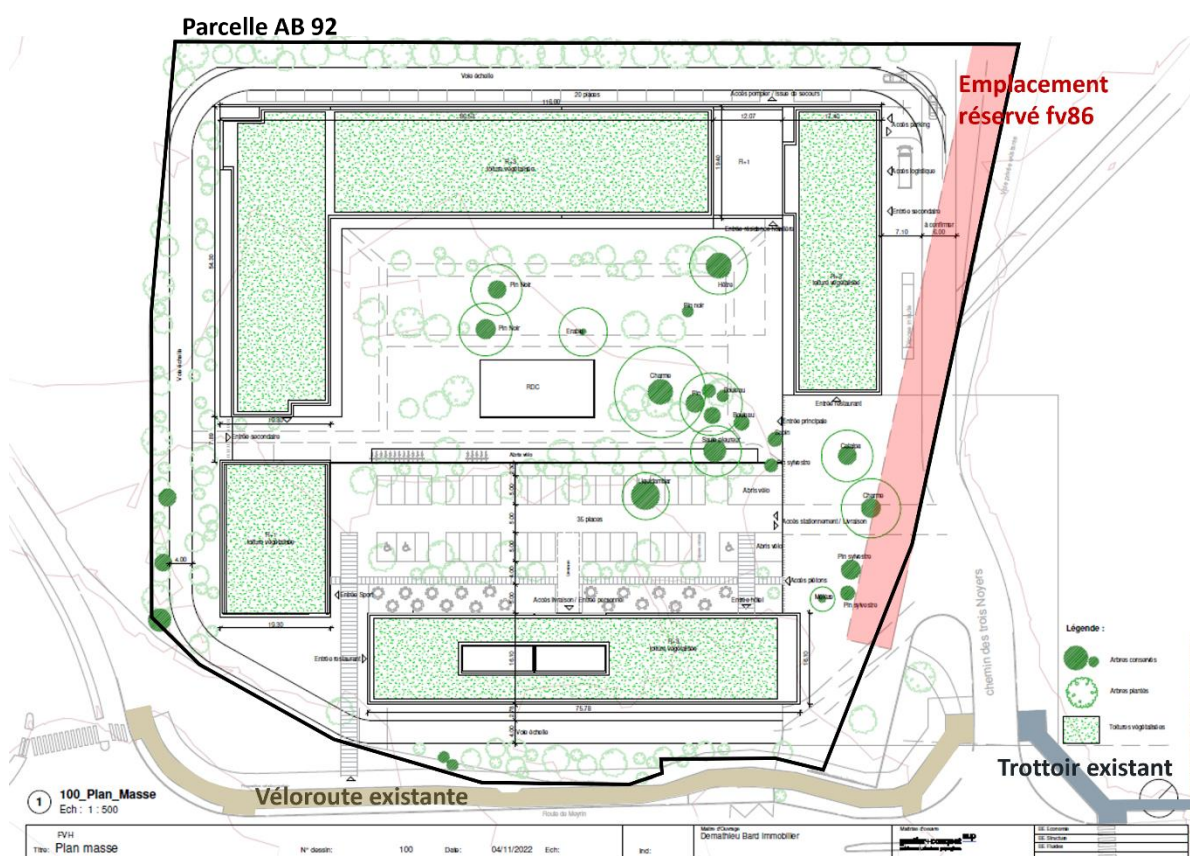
superposition plan masse Novotel / véloroute et ER fv86 (source : Gautier Conquet et haRGENTIC)
